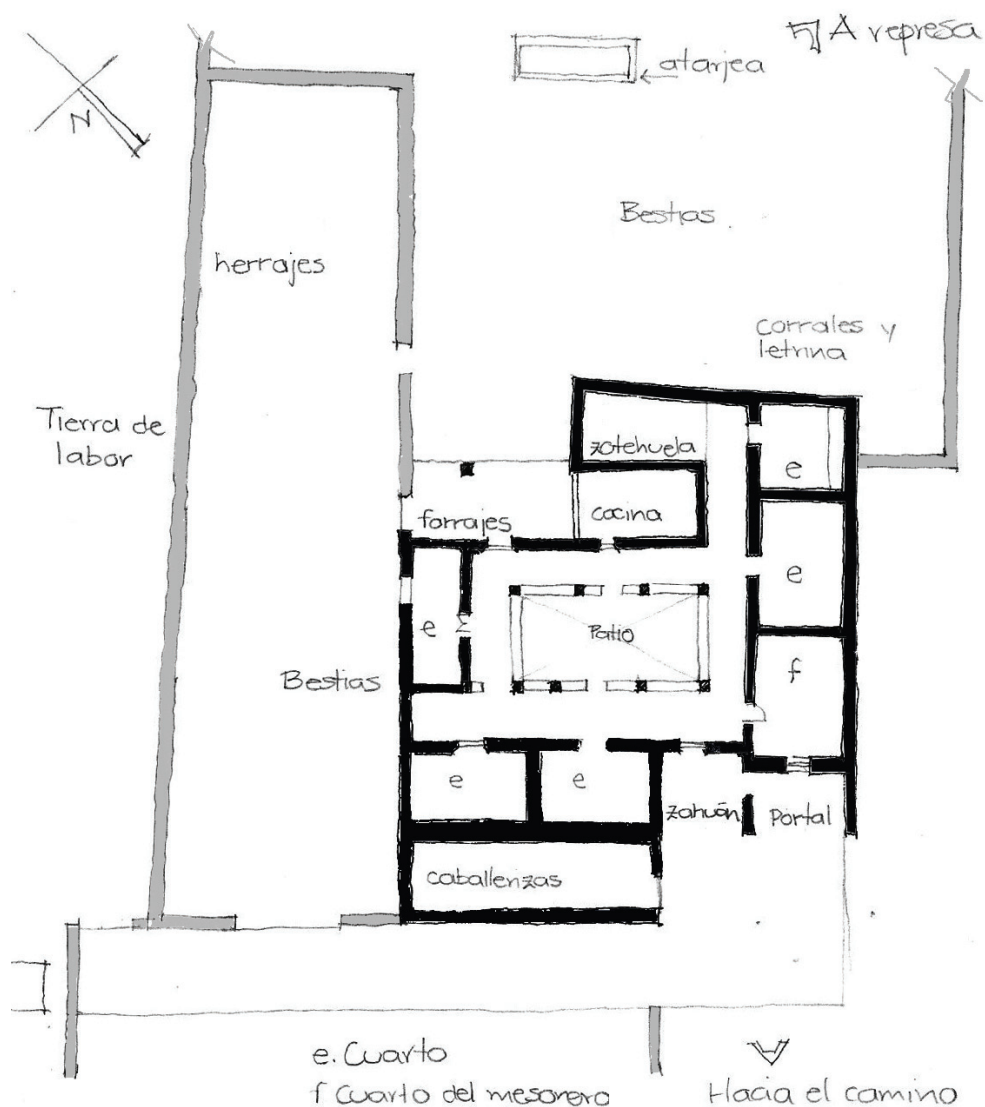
Croquis de la planta arquitectónica de la Venta de Jilotepec del siglo XVIII. Fuente: Bravo Guerrero Sandra. *Ventas y Mesones en la Nueva España, Arquitectura de hospedaje*.
